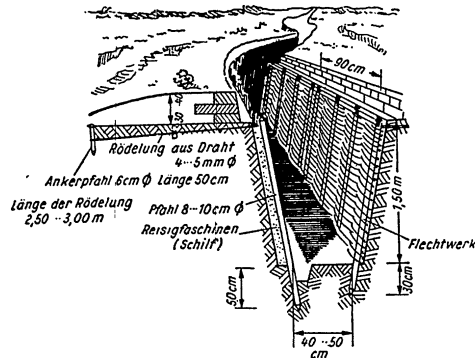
Das Befestigen der Grabenwände mit Faschinen
